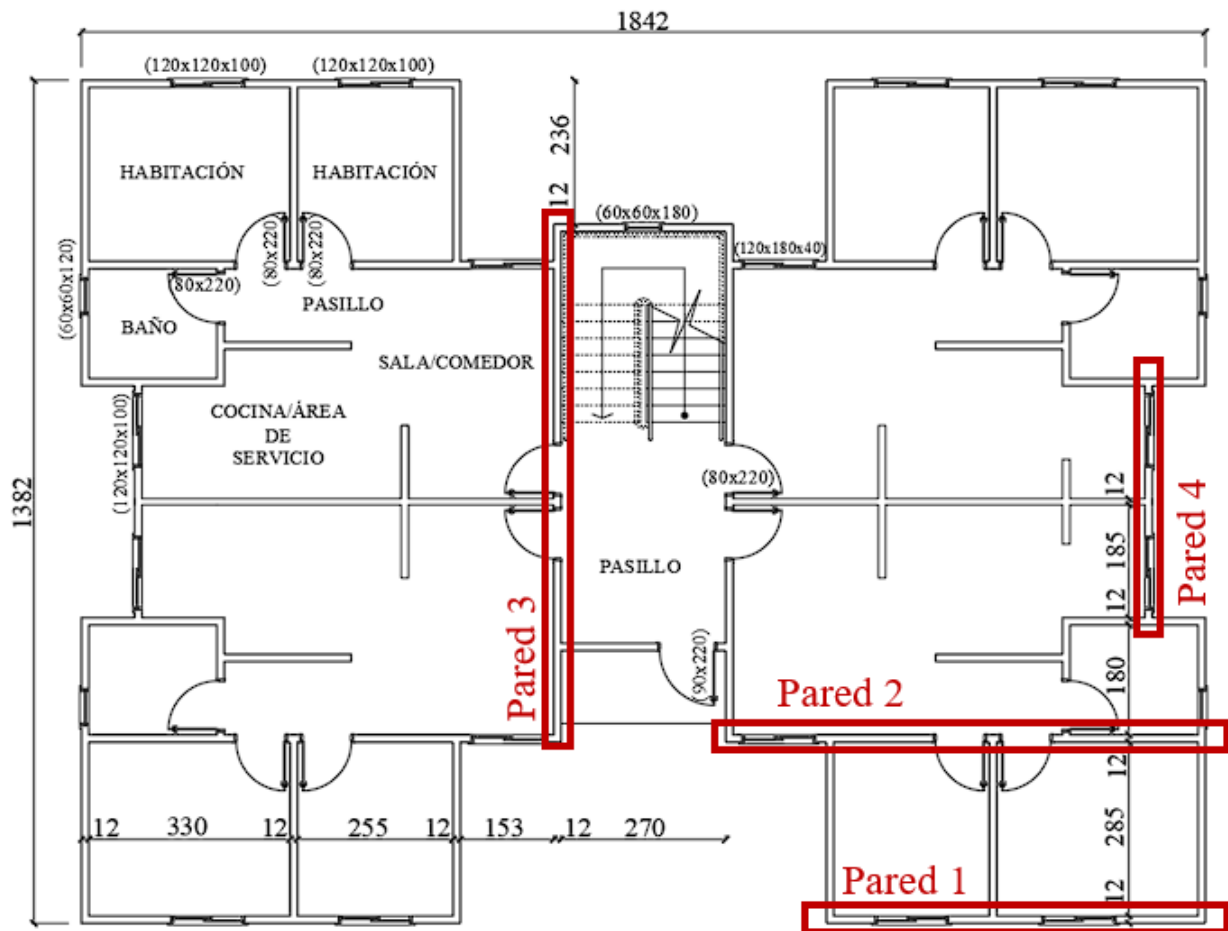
Planta baja de la arquitectura (dimensiones en centímetros).
